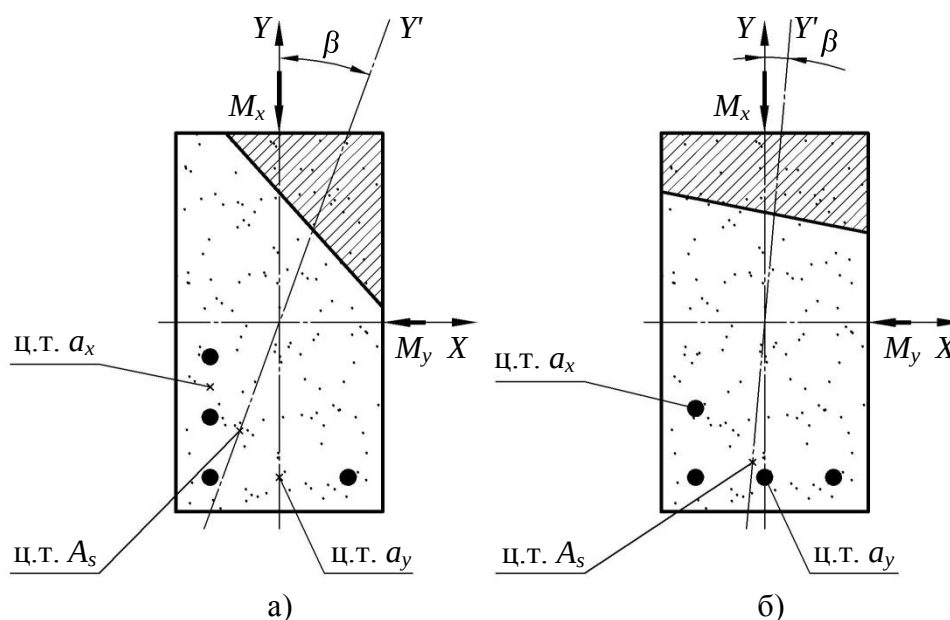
Виды форм сжатой зоны бетона в косоизгибаемом железобетонном элементе: треугольная (а) и трапециевидная (б). Расположение рабочей арматуры в поперечном сечении.
